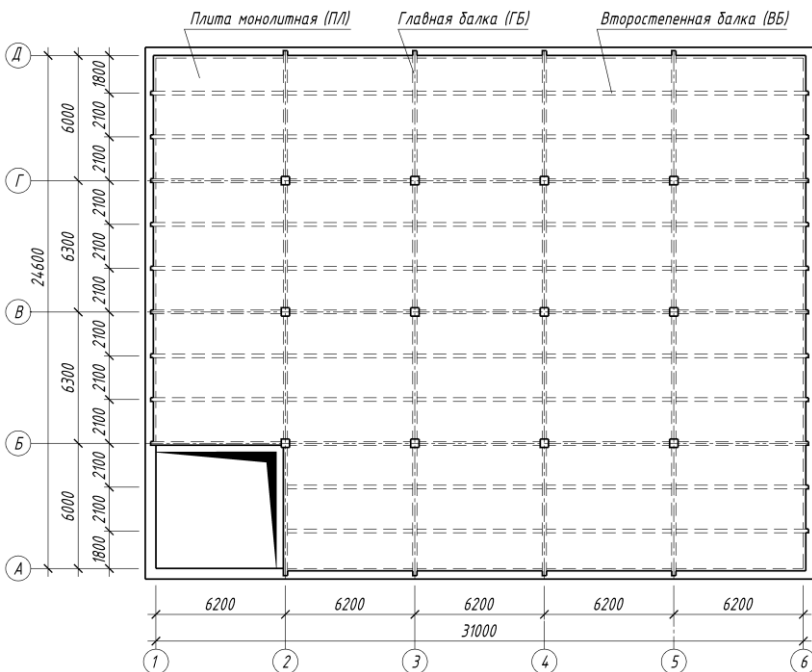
Конструктивная схема перекрытия – вариант 2
